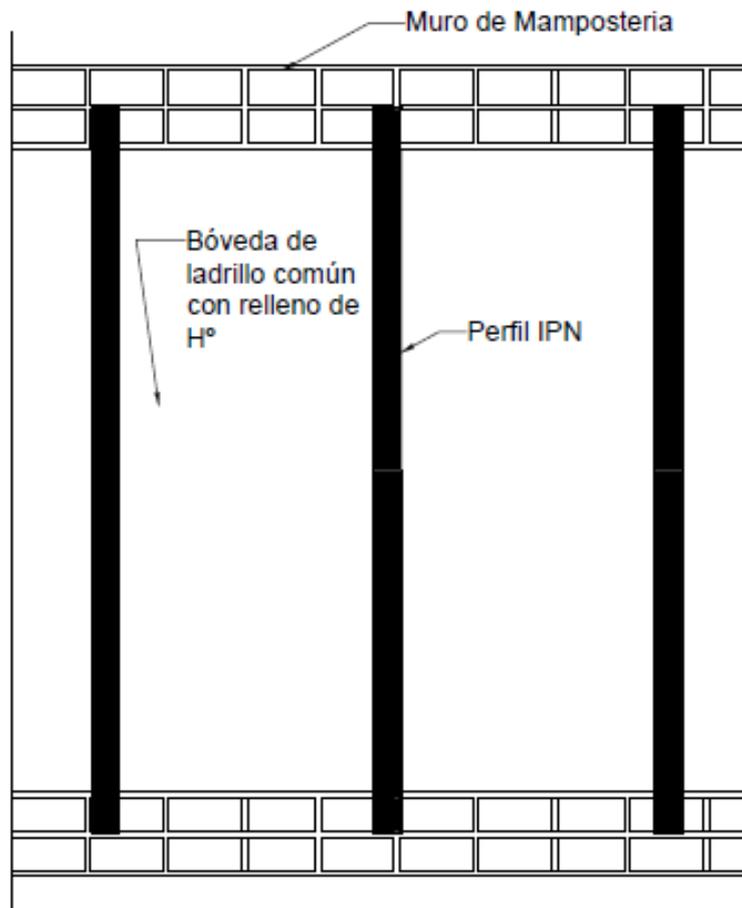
Vista en planta de la losa con la cubierta de chapa retirada.
